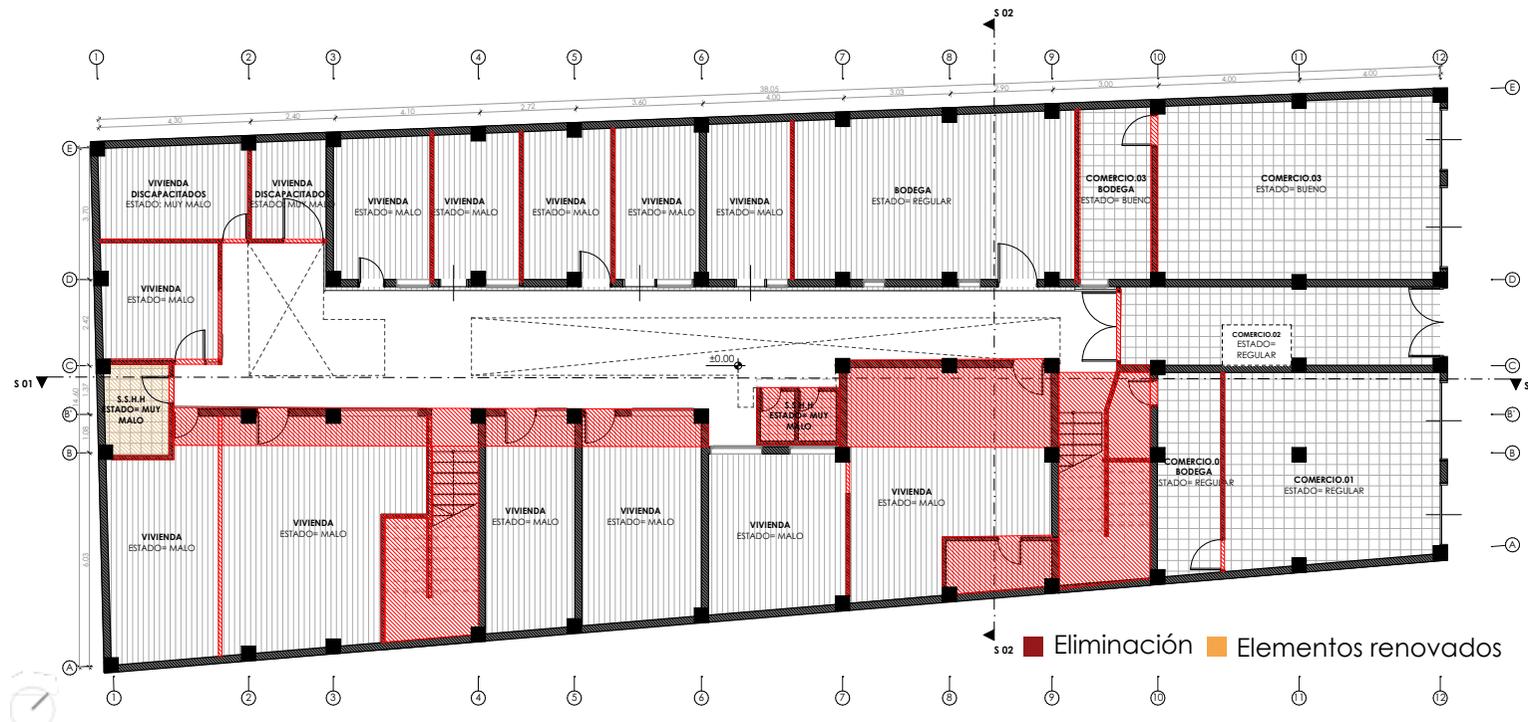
Tramo edificado con la propuesta emplazada. Autoría propia [Ilustración].
